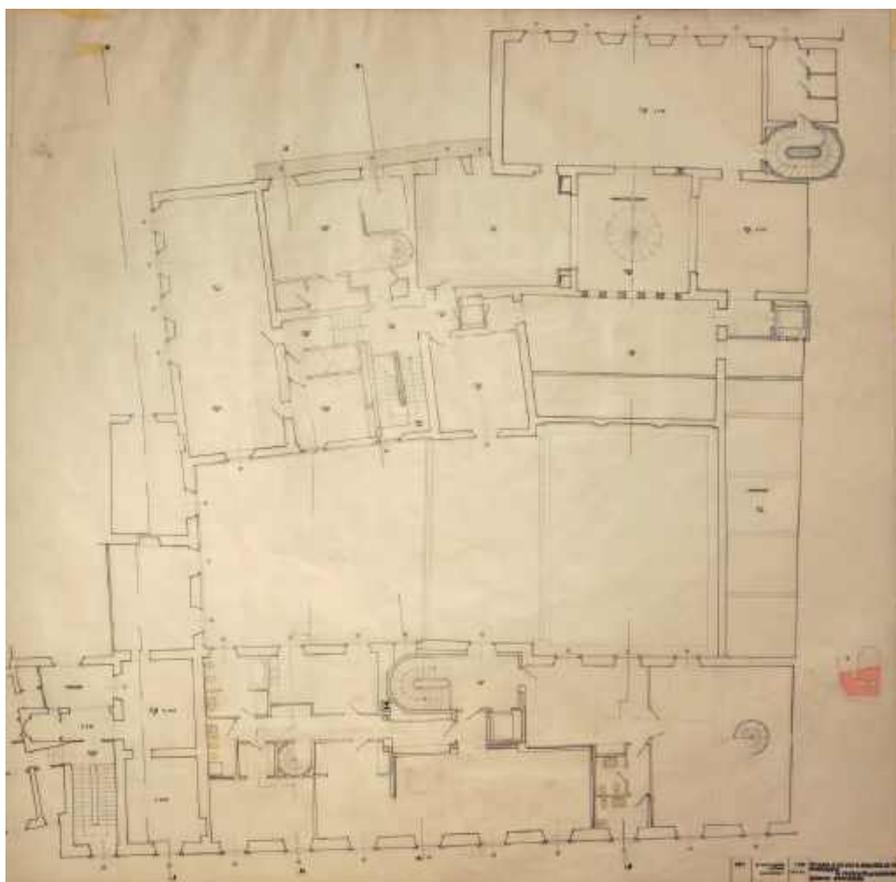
Stabile su via San Maurizio n. 19, corpo nord, pianta piano secondo, progetto di restauro e adattamento a banca; tavola su lucido
